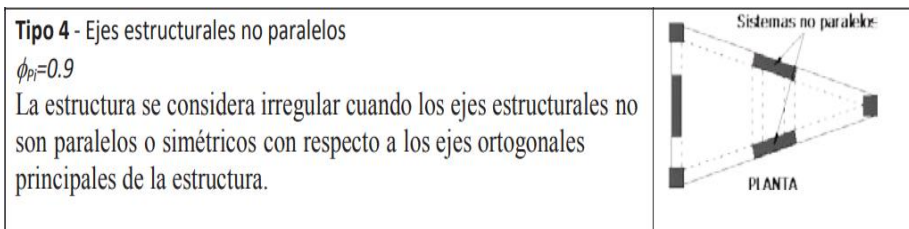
Irregularidad en planta. Tipo 3. Ejes estructurales no paralelas
